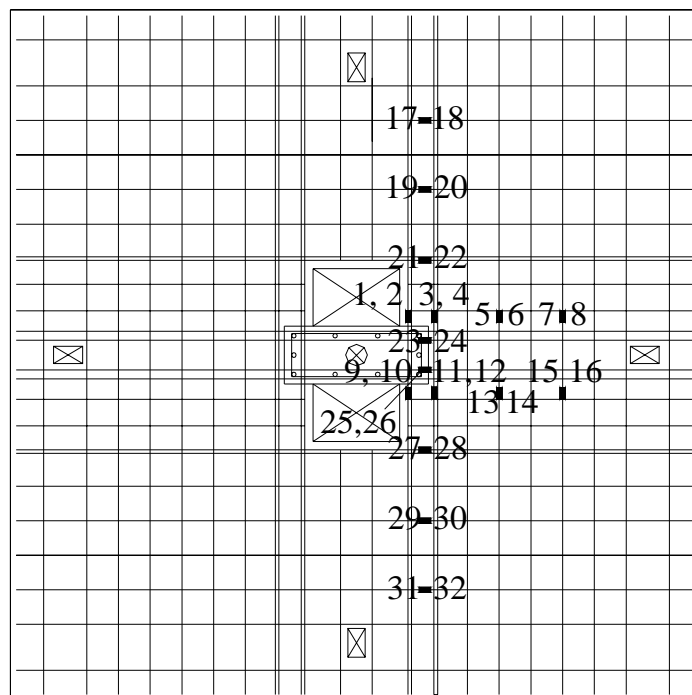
Posicionamento dos EERs no aço para as lajes L18 (mm)
